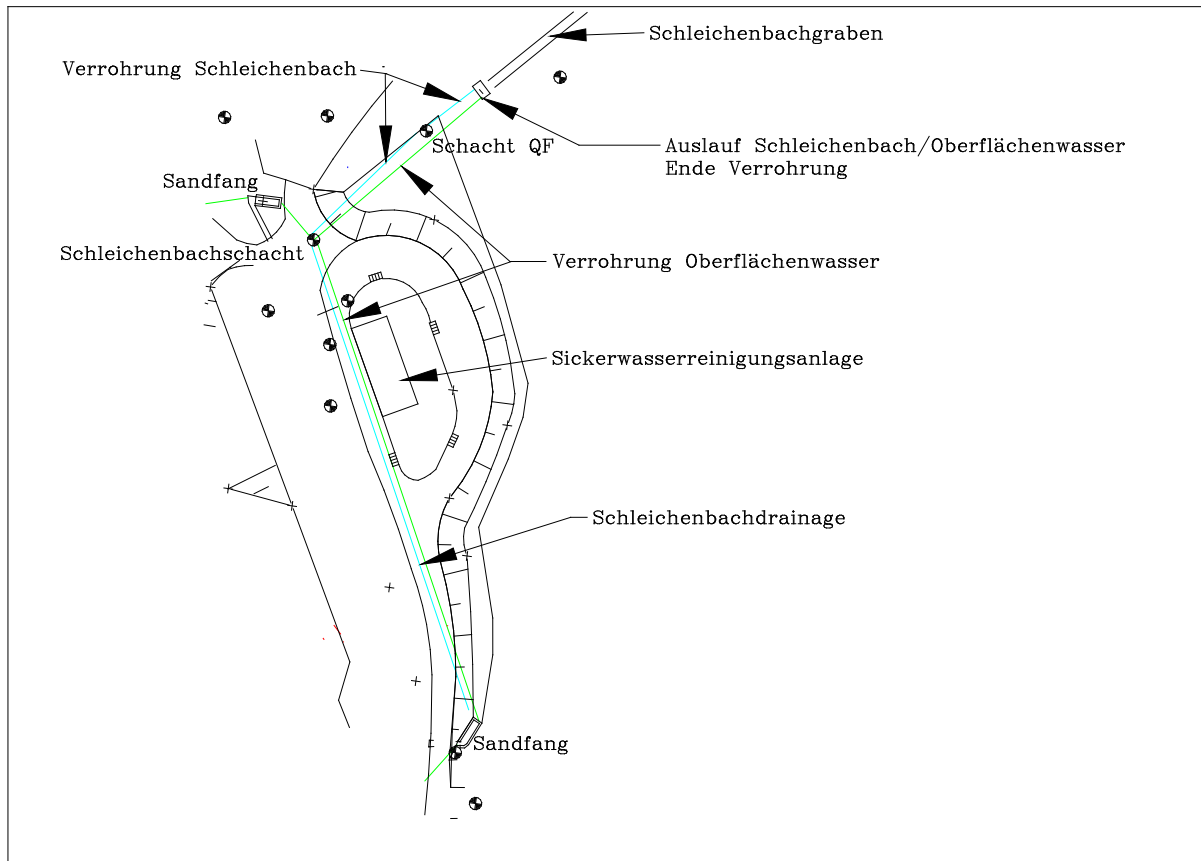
Ausschnitt Lageplan Schleichenbachdrainage / Oberflächenwasserabfluss
